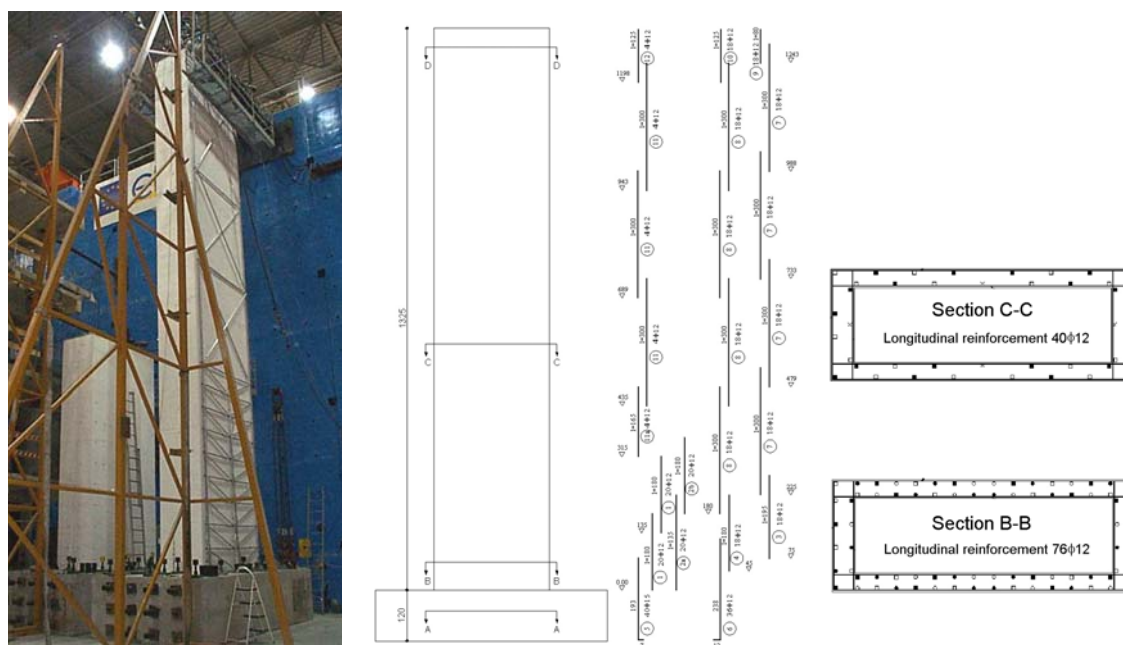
Vista geral e pormenorização da armadura do pilar P3, modelo à escala 1:2.5.
